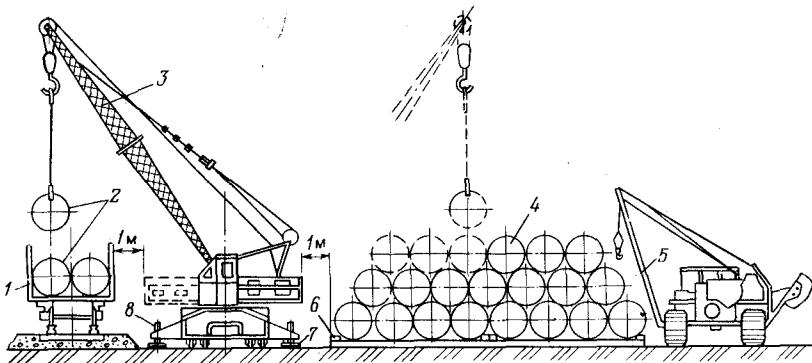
Схема выгрузки труб из полувагонов с укладкой в штабель на временную площадку:
